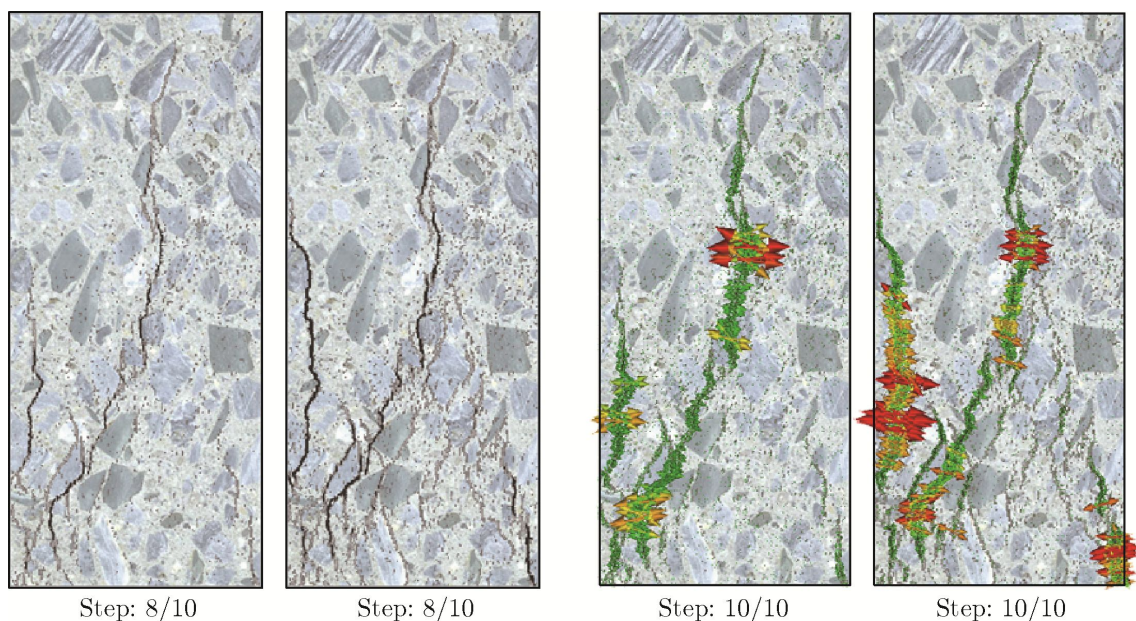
画像計測により得られたコンクリートのひび割れ進展挙動
